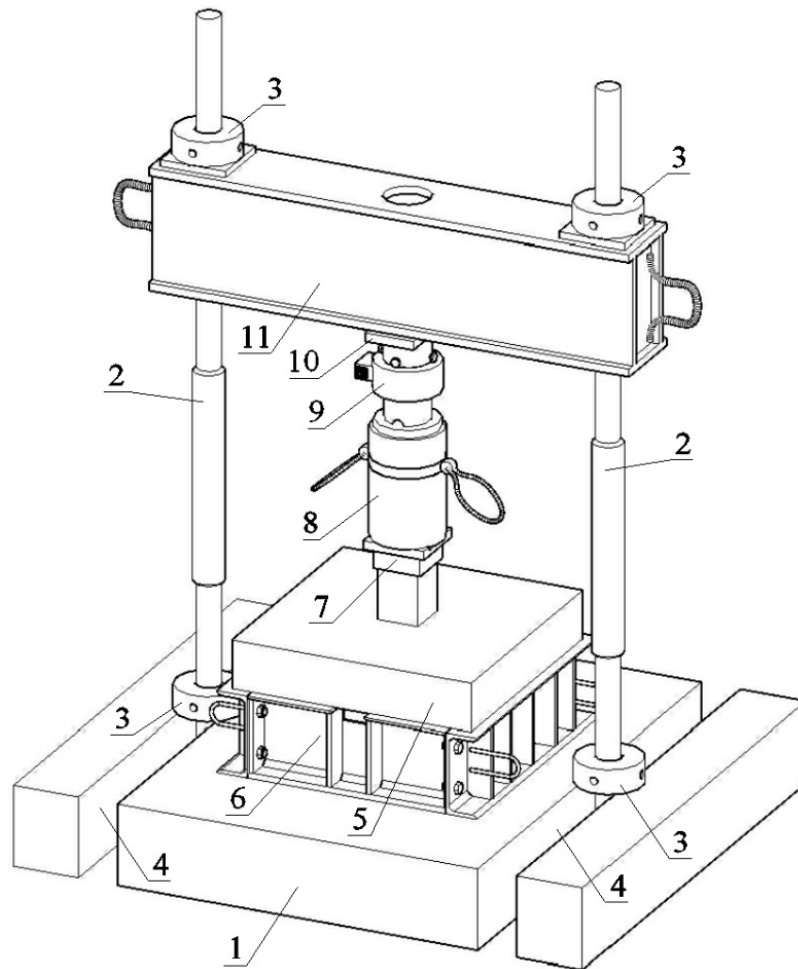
Стенд для проведения испытаний при действии статических нагрузок. Обозначения: 1 - силовой пол; 2 - вертикальные тяжи; 3 - гайки; 4 - ручки силового пола; 5 - экспериментальный образец; 6 - опорный элемент; 7 - оголовок колонны; 8 - гидравлический домкрат; 9 - силоизмеритель; 10 - распределительная пластина; 11 - упорная траверса
